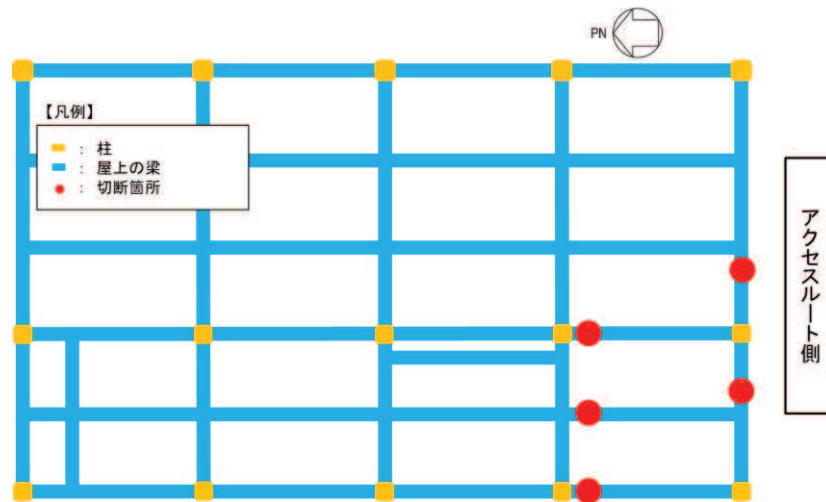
第3号機給排水処理建屋構造材切断位置（屋上平面図）
